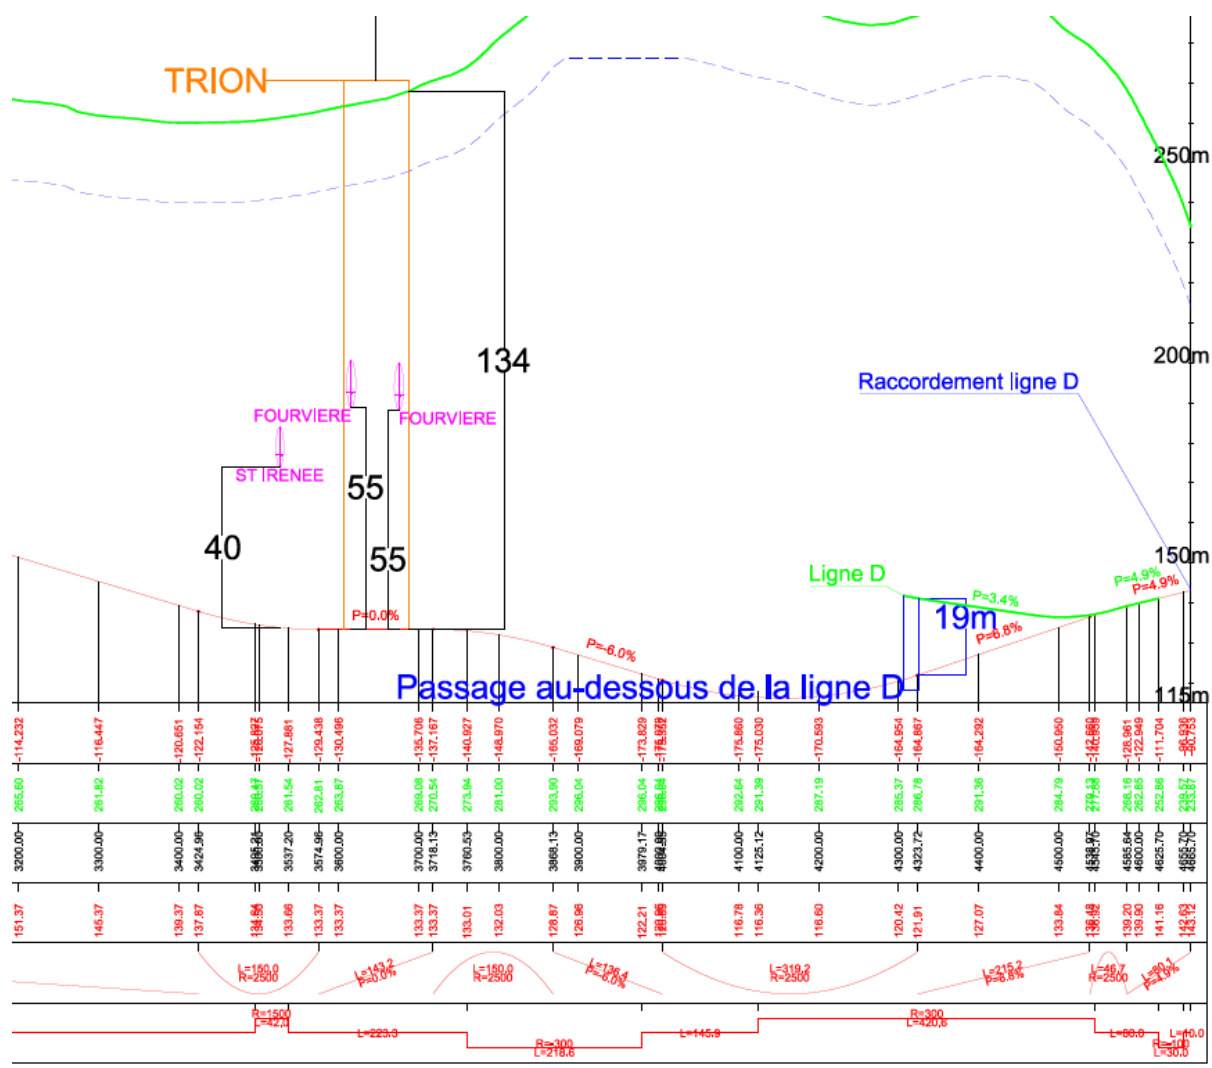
Tracé 1 – Profil en long au droit de la station Trion
